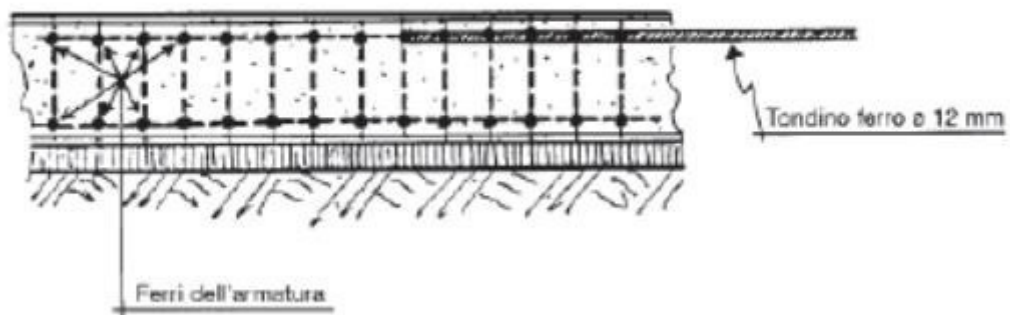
Esempio di platea di fondazione con connessione ai ferri dell'armatura
